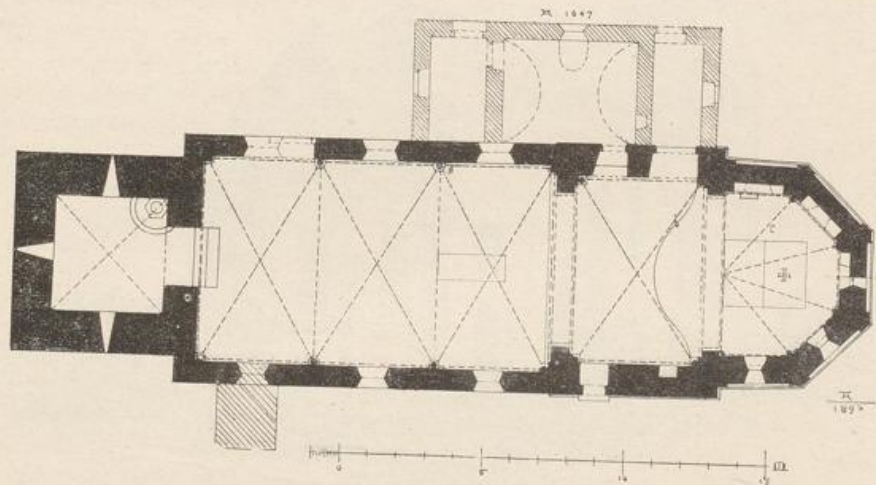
Lüftelberg Kathol. Pfarrkirche. Grundriss.
